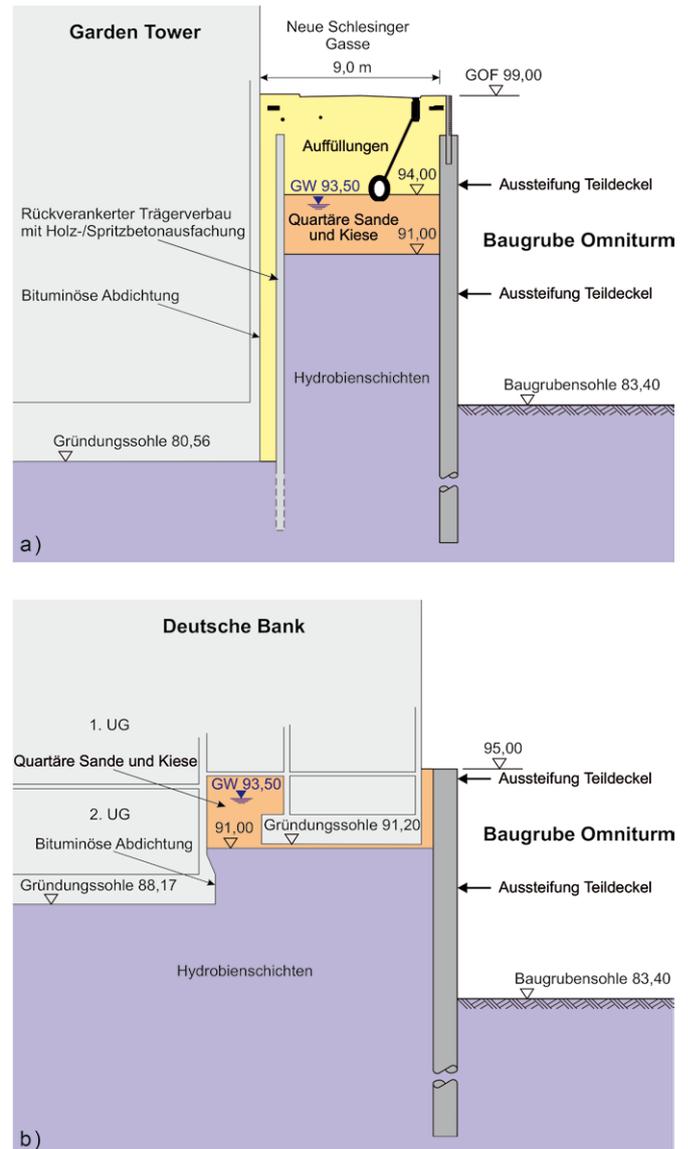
a) Schnitt A-A: Garden Tower, b) Schnitt B-B: Deutsche Bank
